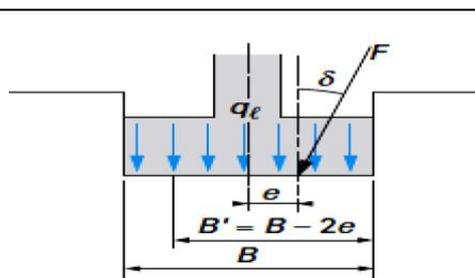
Inclinaison et excentrement d'une charge dans la direction parallèle à B.
